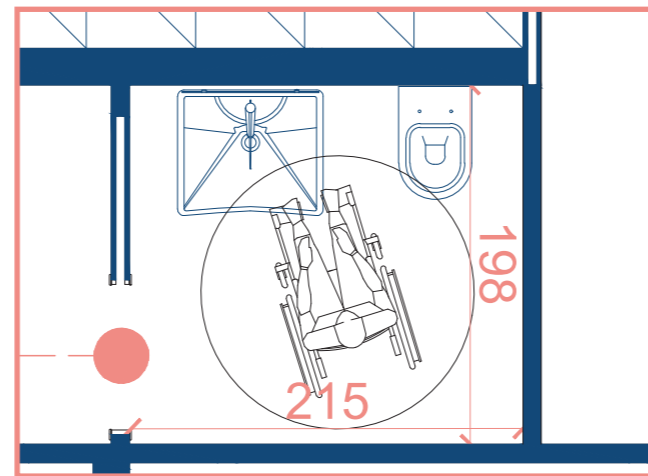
Accessibilità, coworking, dettaglio servizi
